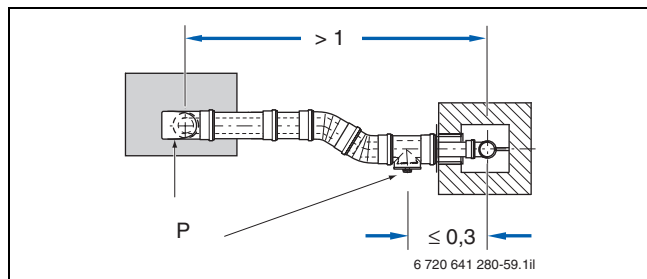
Esempio di disposizione delle aperture di ispezione (P) in caso di tubazione di scarico con deviazioni nel locale di posa – vista dall'alto (misure in m)
